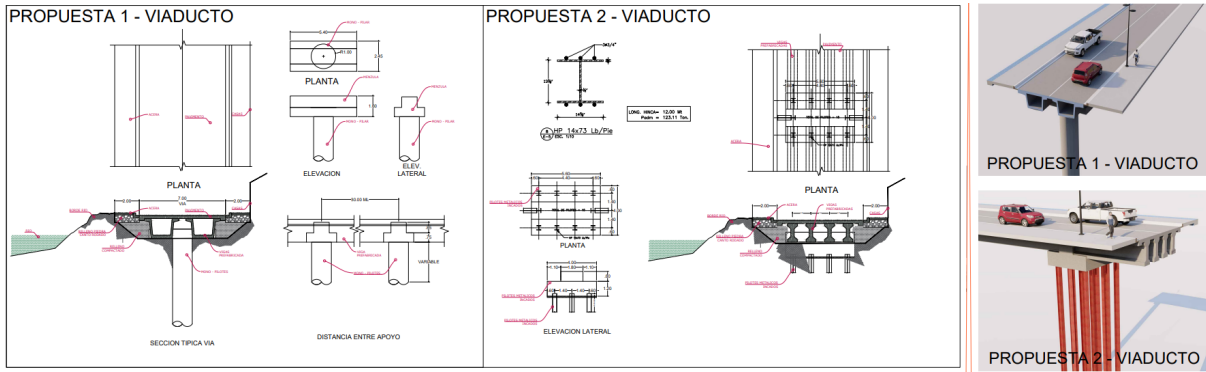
Propuesta de viaductos para la construcción de vía. Fuente: URBE, octubre 2025
